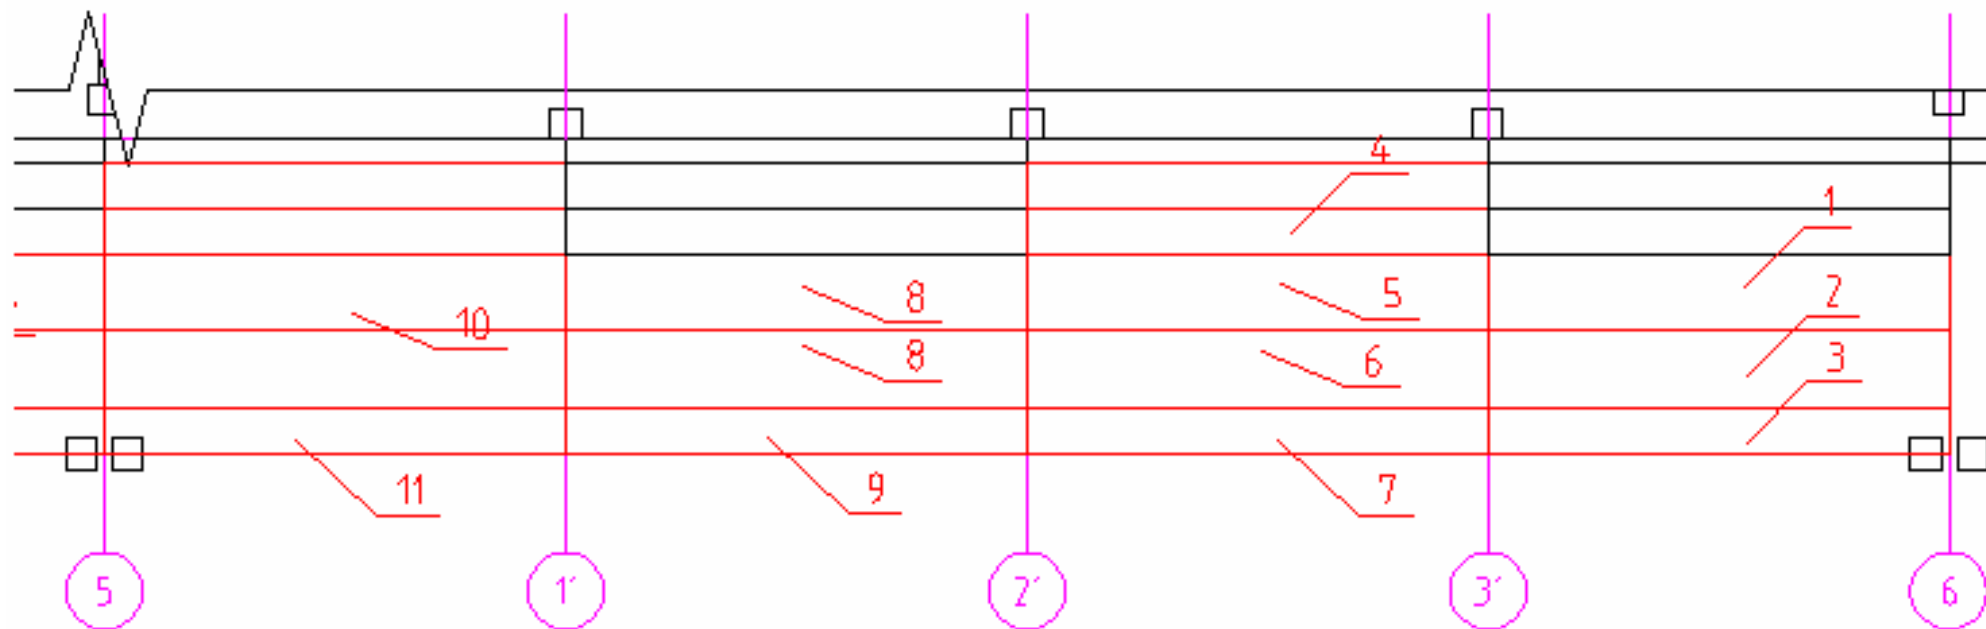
Карта дефектов плит перекрытия пандуса с осях «5–6/А».
